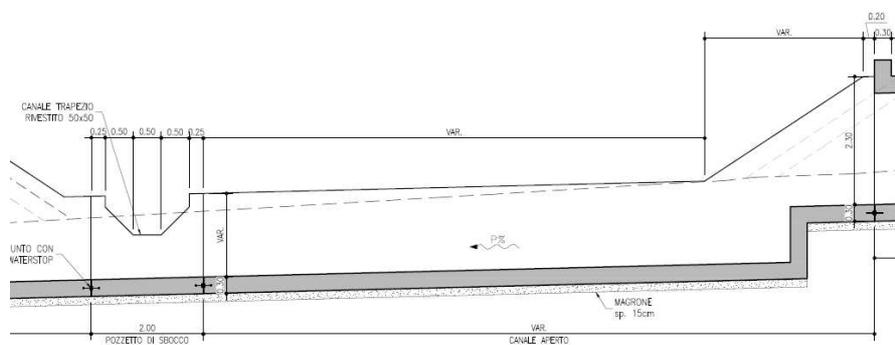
Manufatto di sbocco - Sezione longitudinale
